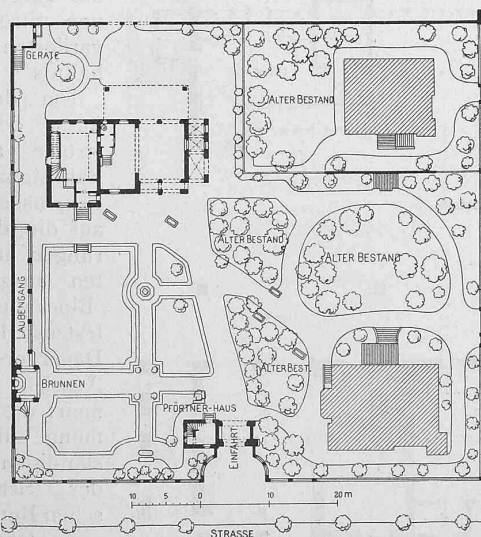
Lageplan zum Lusthaus Reiner — 1:1000.
